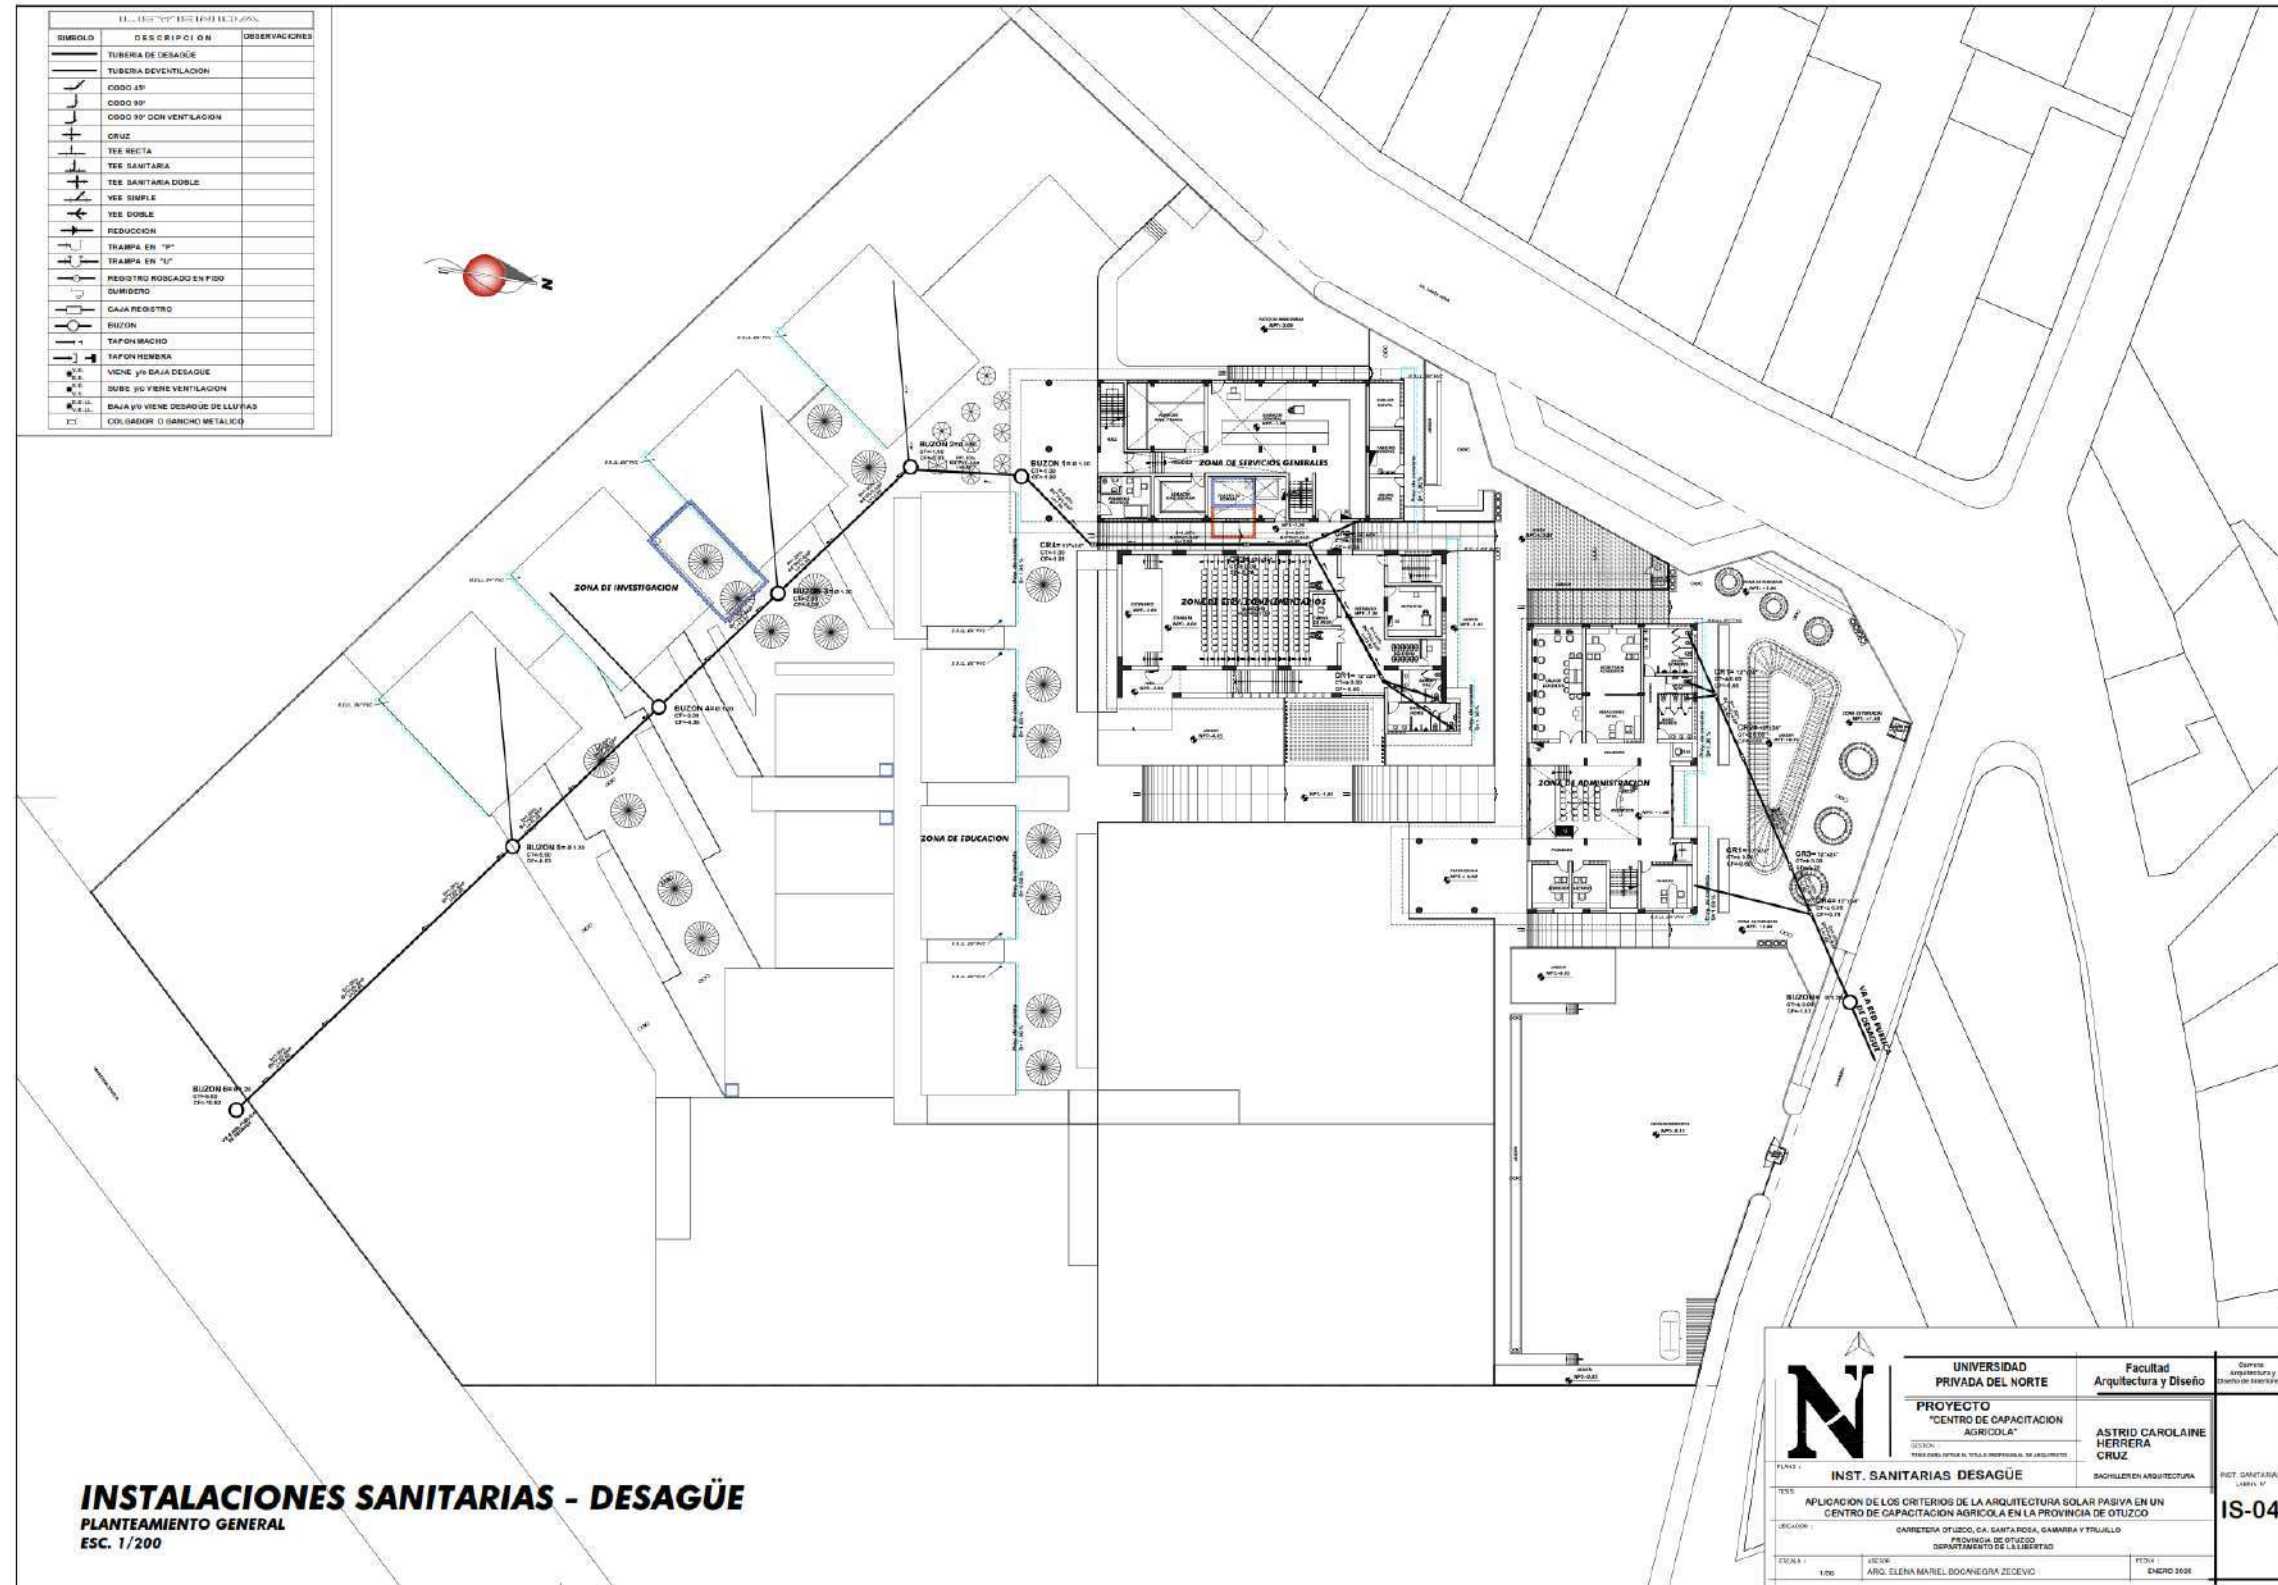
Plano general de Red de Desagüe- Inst. Sanitarias
